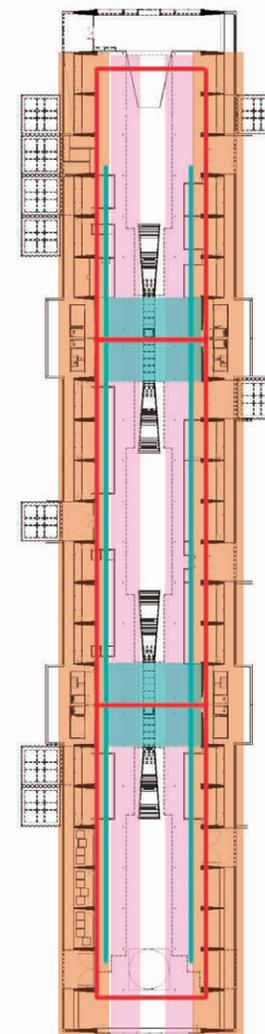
Planta baja y planta tipo de la biblioteca Vasconcelos. Fuente: Elaboración propia con información del Taller de Arquitectura X TAX
